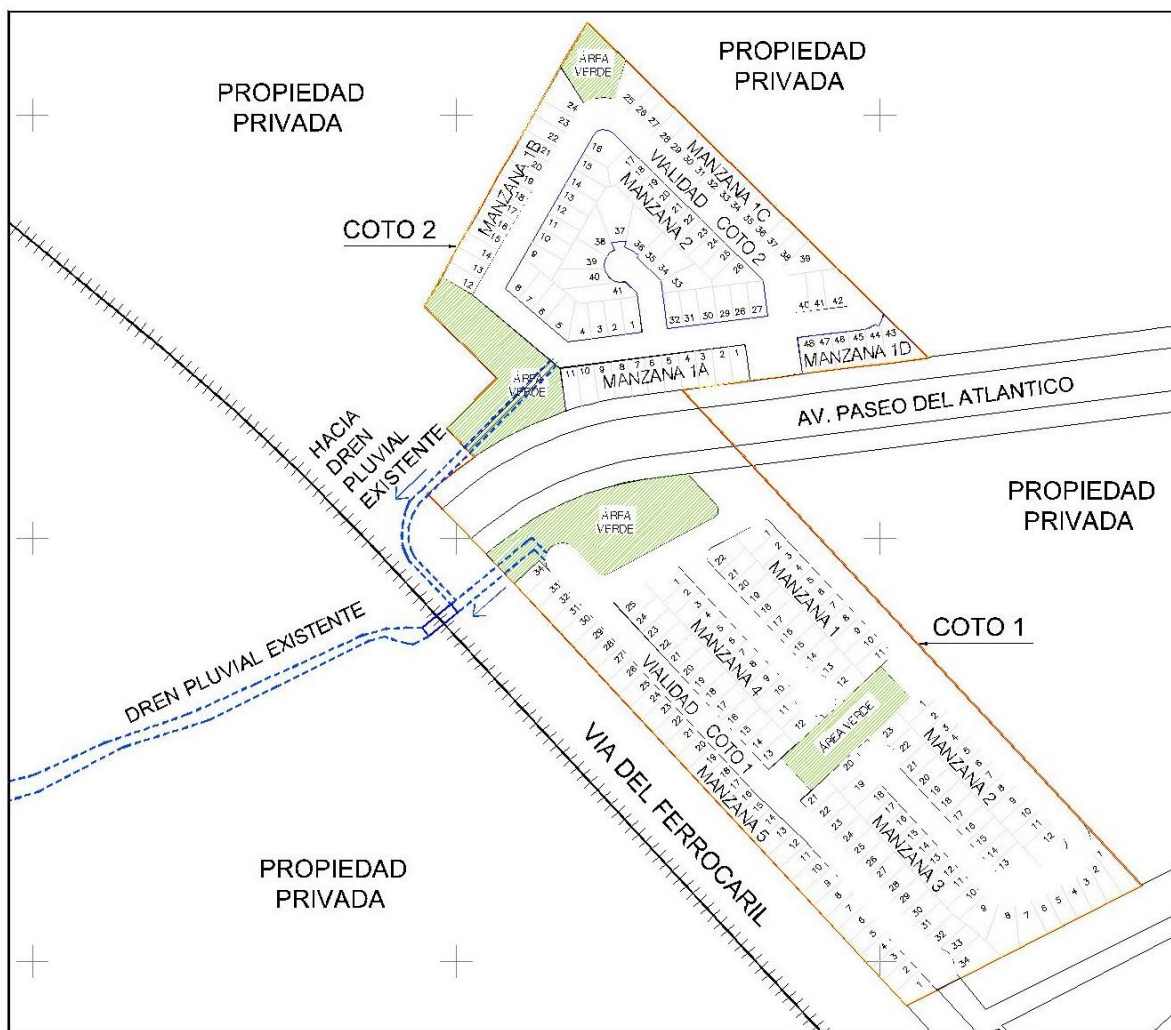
Estructuras dren, una en cada coto, con salida a dren pluvial natural existente.
